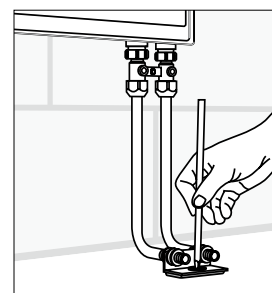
Applicazione del segno corrispondente al punto di fissaggio
